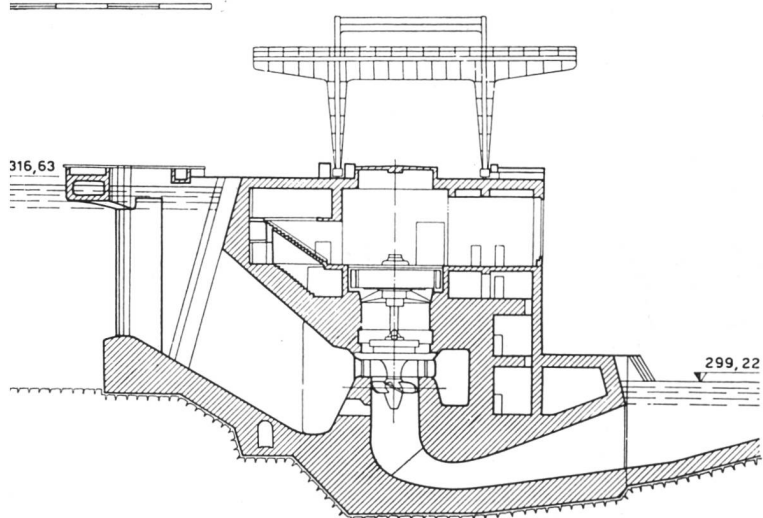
und 11 Querschnitt durch die Wehrröffnung und durch Pfeiler/Maschinengruppe des Pfeilerkraftwerks Vuhred an der jugoslawischen Drau
